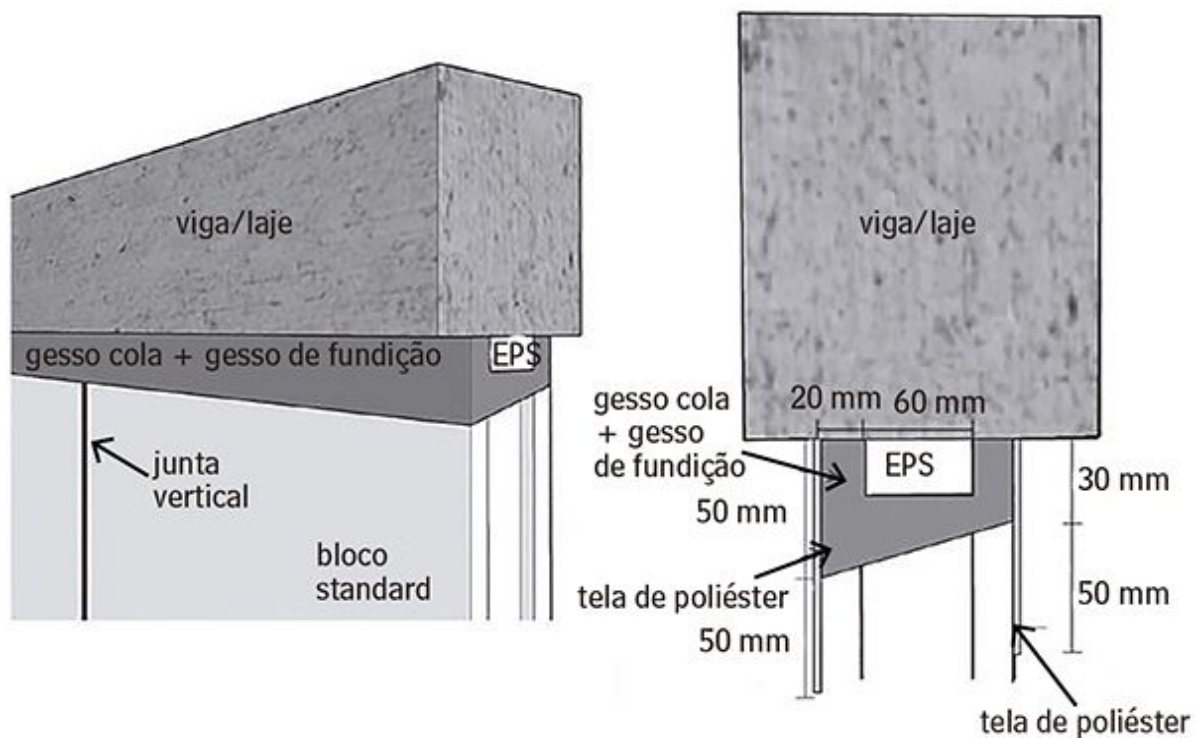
Ligação entre blocos de gesso e viga ou laje maciça
